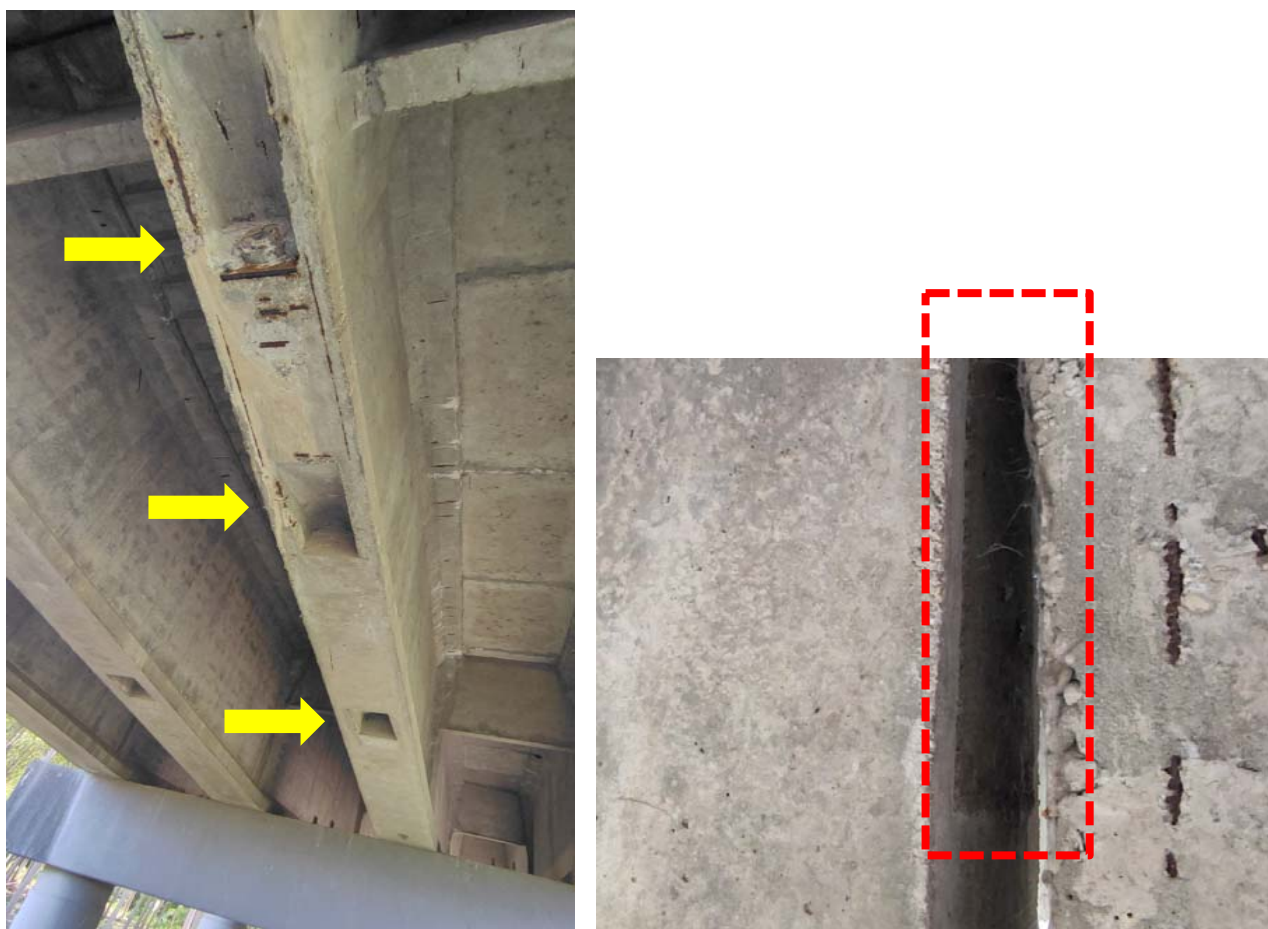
teste di partenza dei cavi di precompressione, rilevate presso le travi su pila
